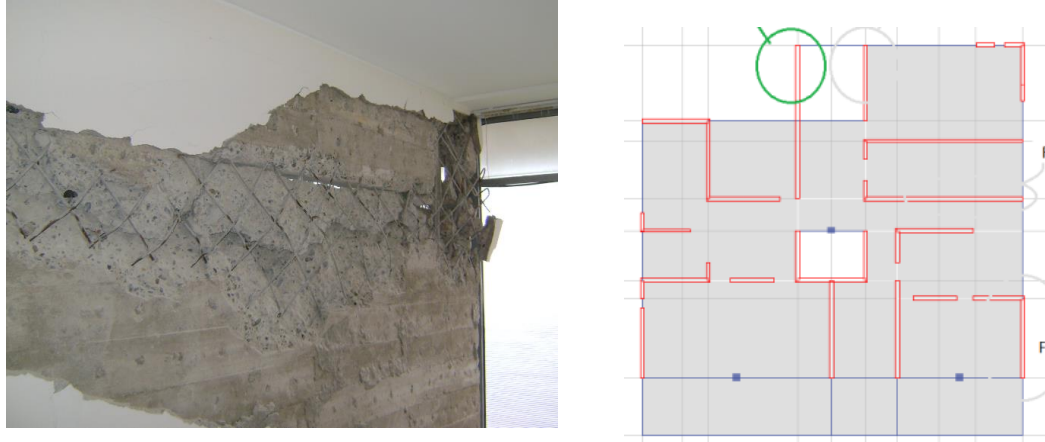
Imagen del daño y ubicación en planta del elemento B4-4
